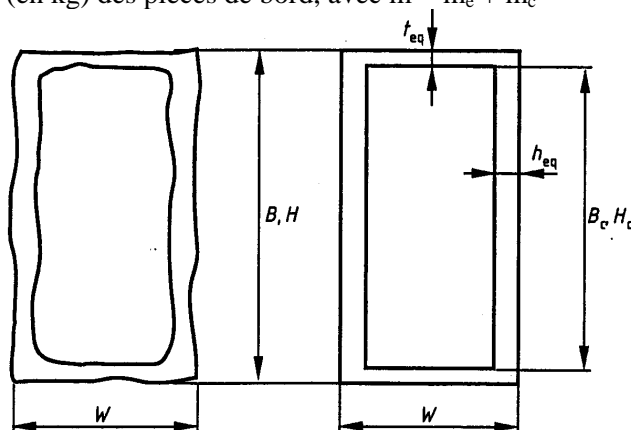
Modélisation d'une brique de construction ou d'un carreau en verre creux
